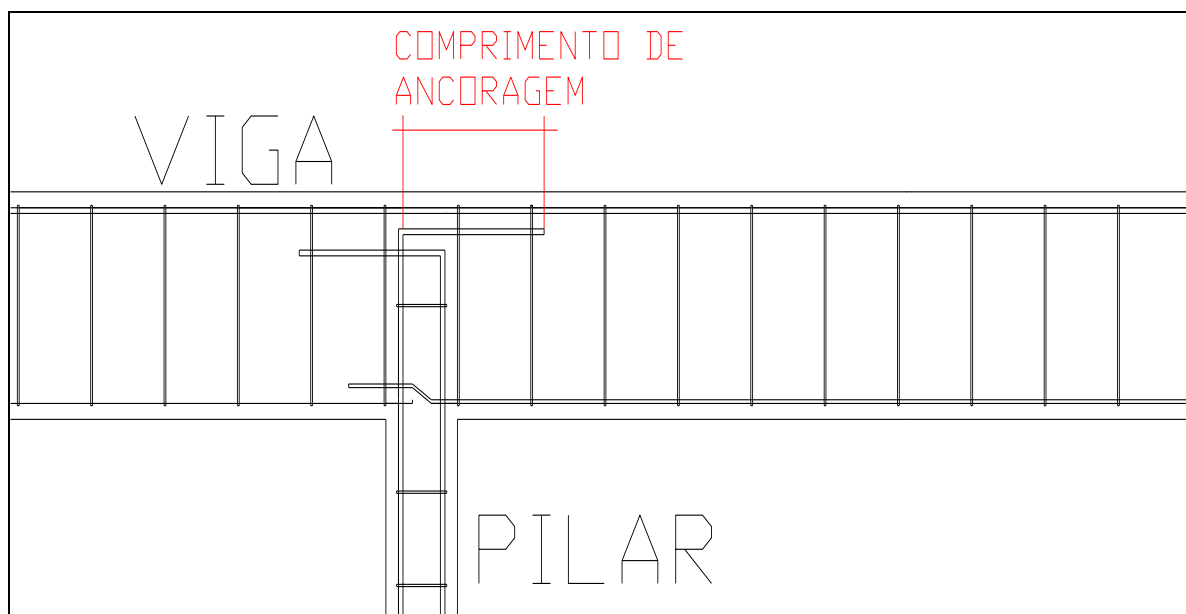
Croqui de “amarração” de armaduras viga x pilar
